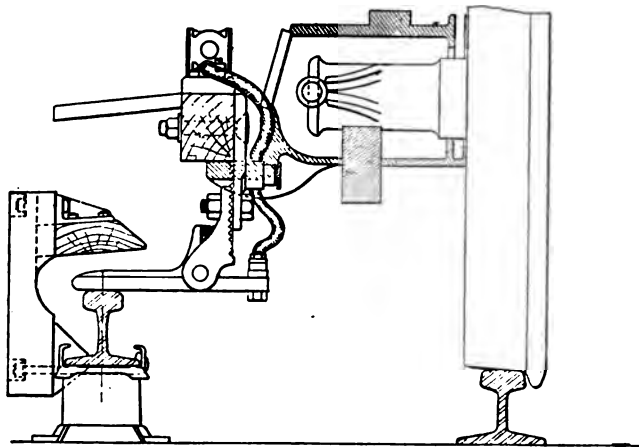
Isolateur et 3^e rail avec protection de la Wilkesbarre and Hazleton C^o.
